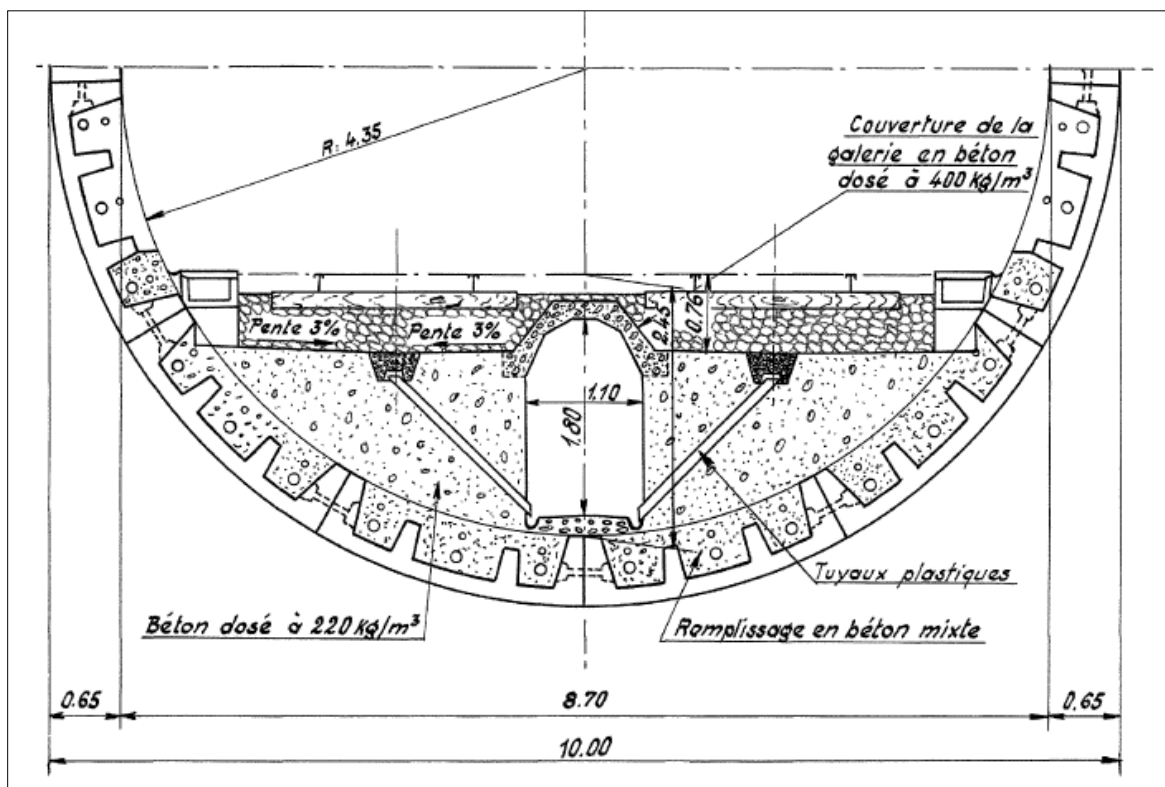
Coupe schématique d'ouvrage type tunnelier avec galerie centrale servant au drainage
